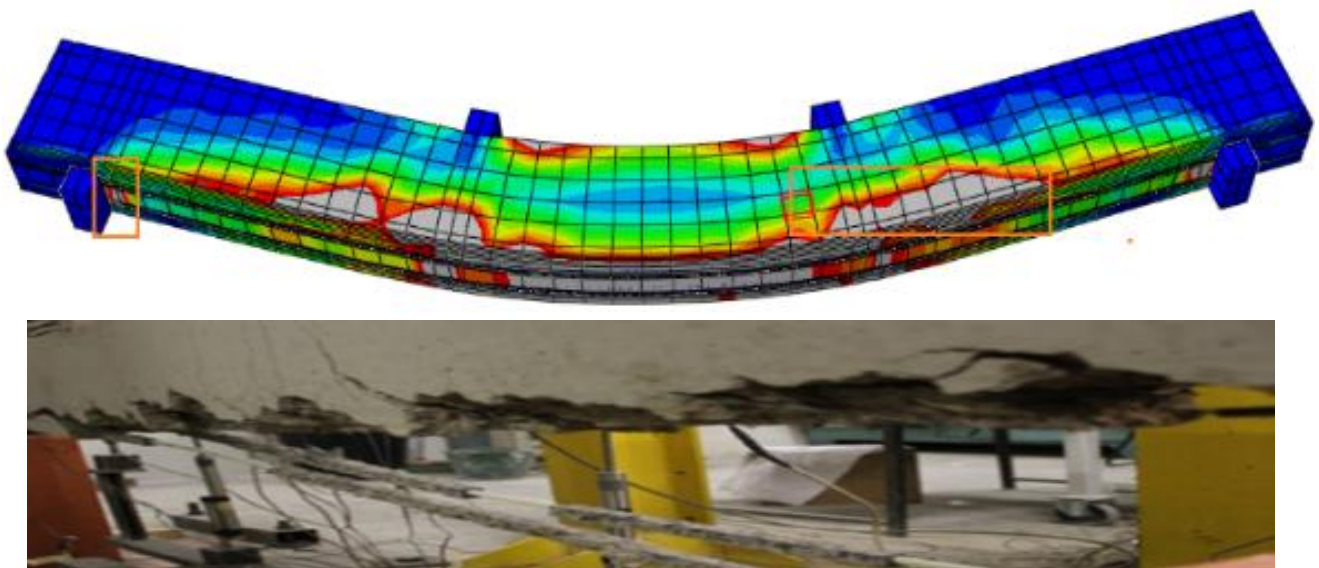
Comparaison des modes de rupture de la poutre renforcée par la technique NSM avec une poutre issue de la littérature.
